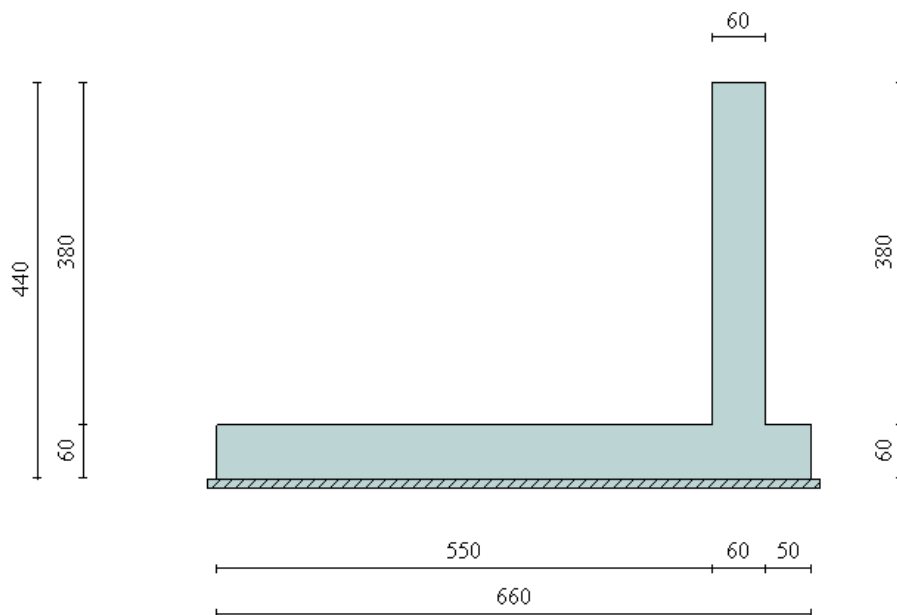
Schema semplificato della sezione trasversale di maggior altezza dell’opera di derivazione
